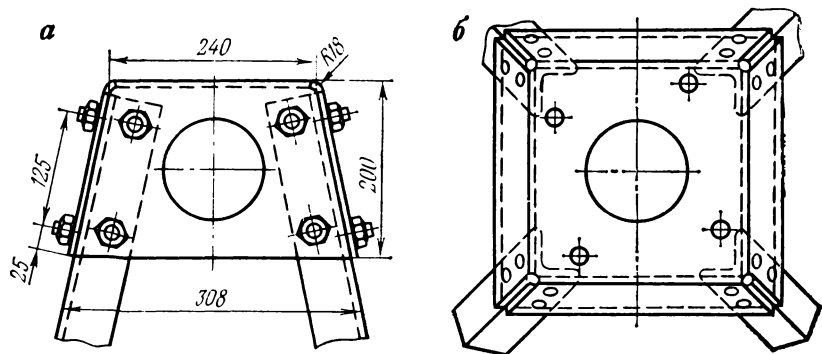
Деталь крепления ног в верхней части металлической пирамиды (коробка):
